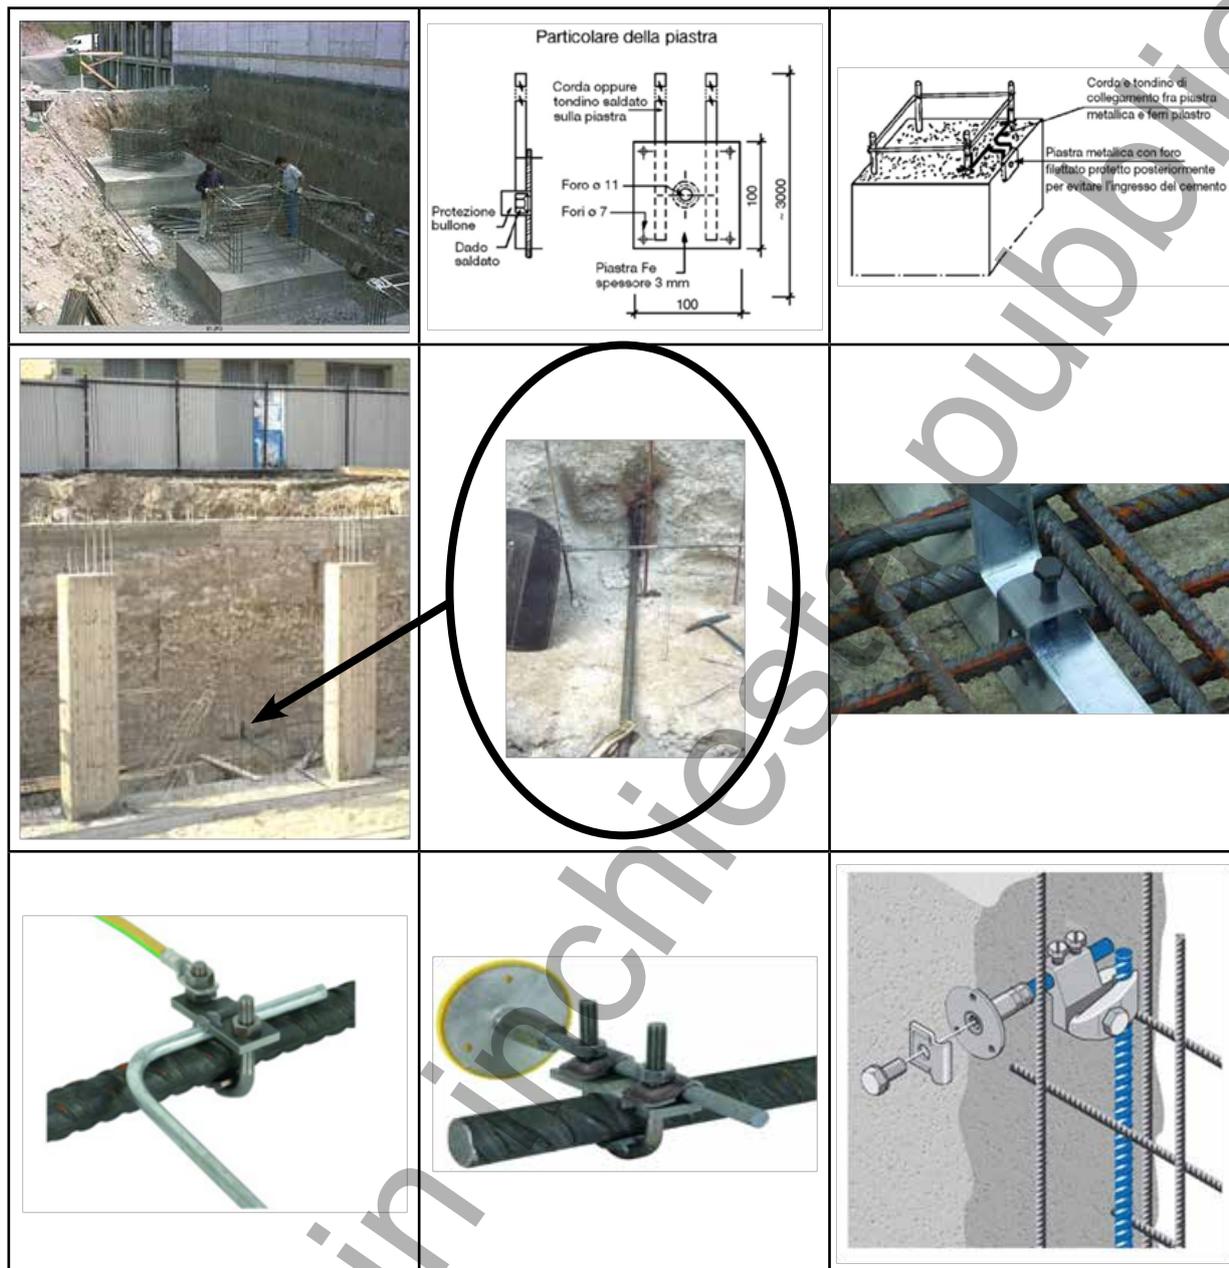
Esempi di collegamento ai ferri del pilastro o del plinto con piastra metallica (o con altri elementi metallici) incorporata nel getto del calcestruzzo, particolarmente adatti per elementi prefabbricati
